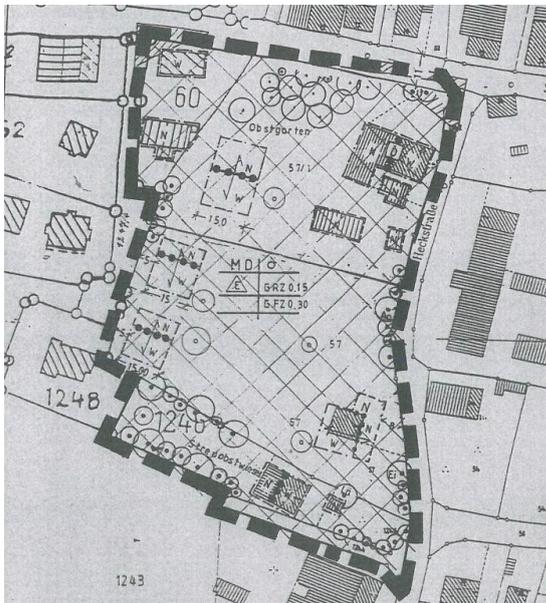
Ursprungsbebauungsplan „Dießen IV b Dettenschwang - Heckstraße“
